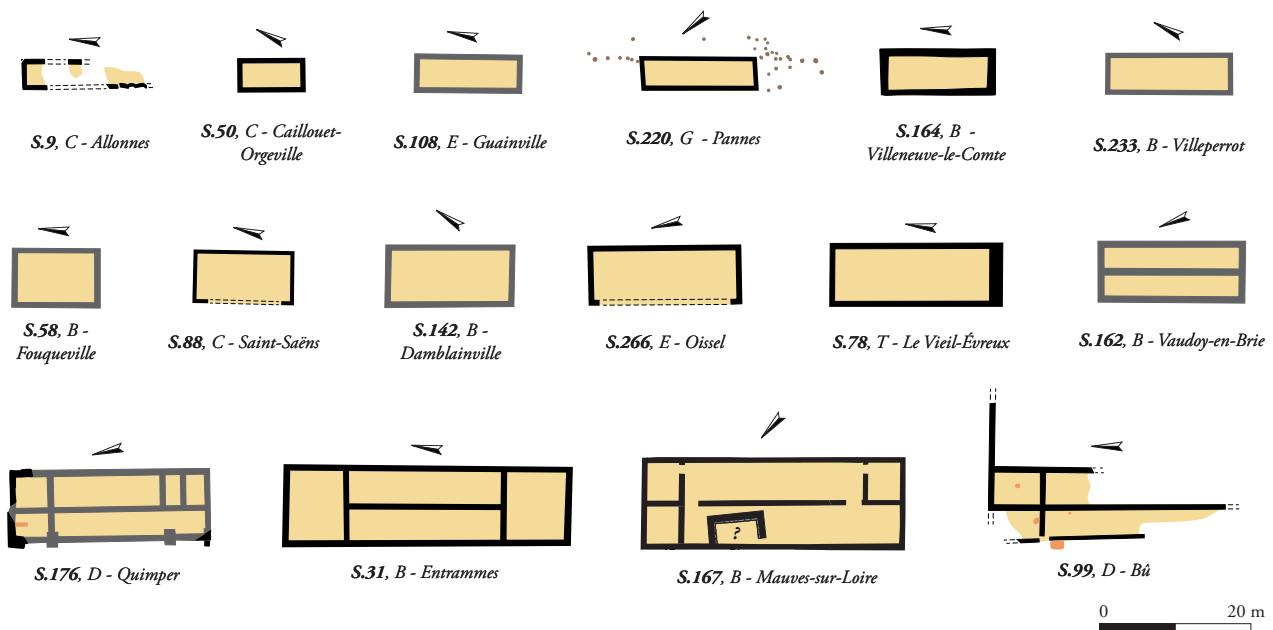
plan de bâtiments de plan barlong indépendants de tout périmètre maçonné, installés le plus souvent à l'est du temple.
